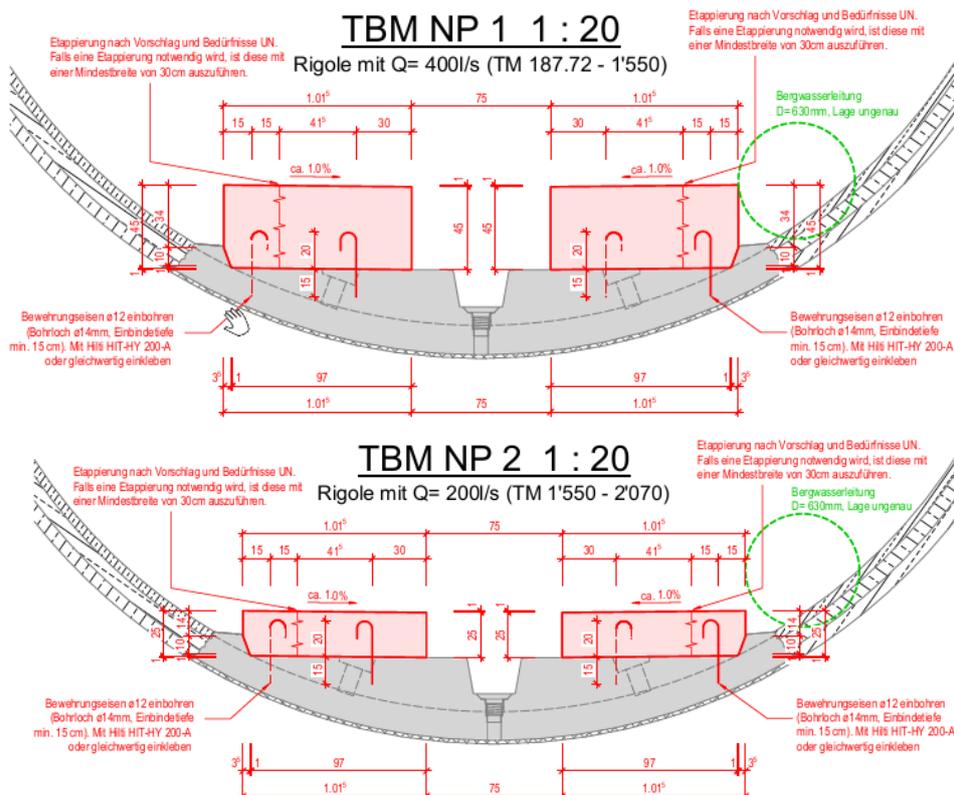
Sohlelement (rot) zur Vergrösserung der Rigole (Ausführung evt. in Ortbeton).
